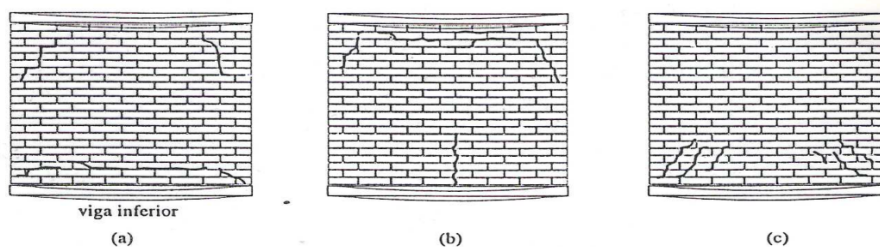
Configurações possíveis de trincas devido a deformações das vigas de apoio. (Silva e Jonov)
